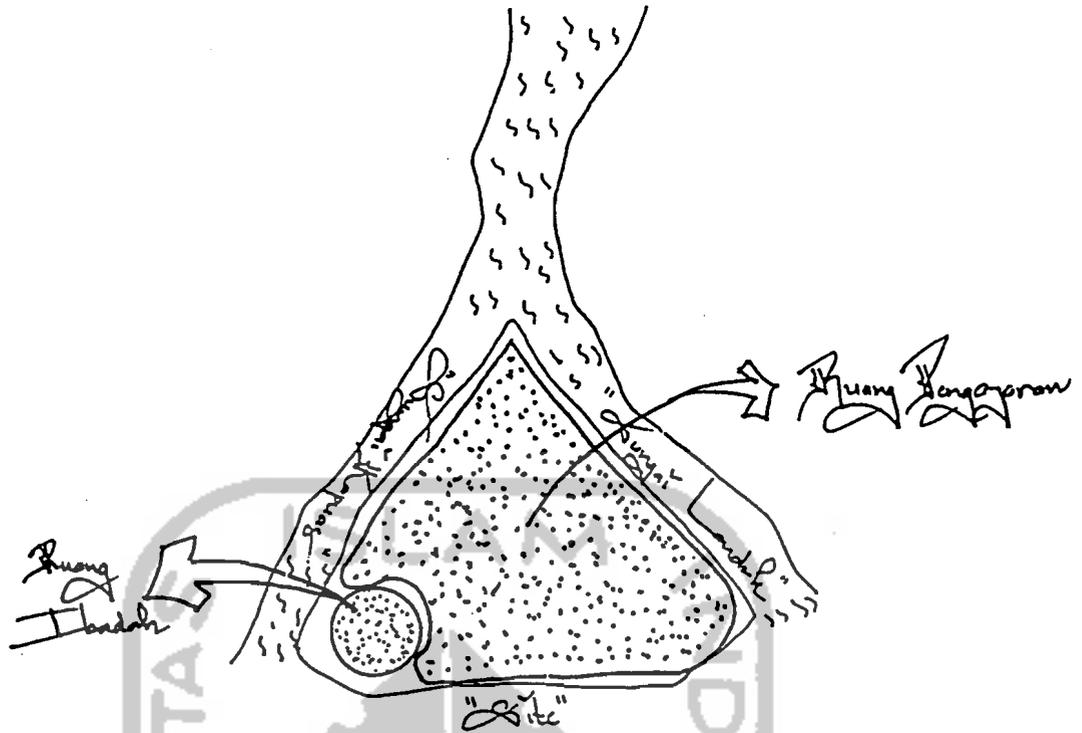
Bentuk Ruang Sirkulasi pada Site.
